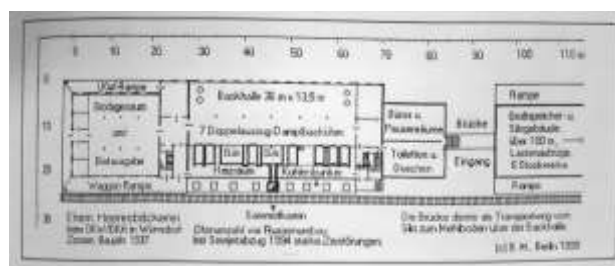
Grundrisssskizze einer Heeresbäckerei, hier Wünsdorf/Berlin. Rechts der Übergang zu den Speichergebäuden.
